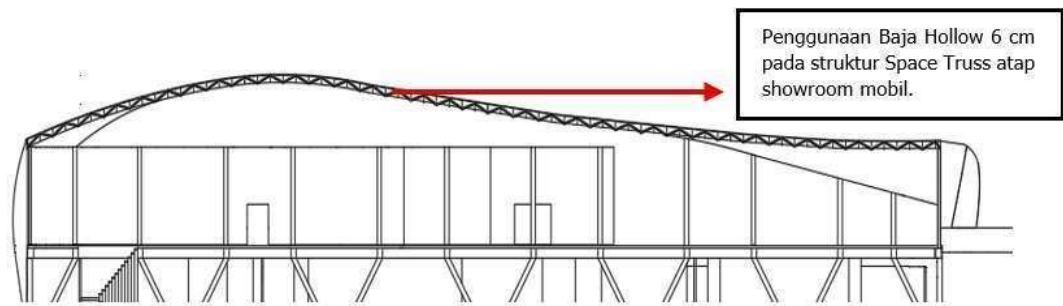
11 Penggunaan Struktur V sebagai struktur tengah bangunan
